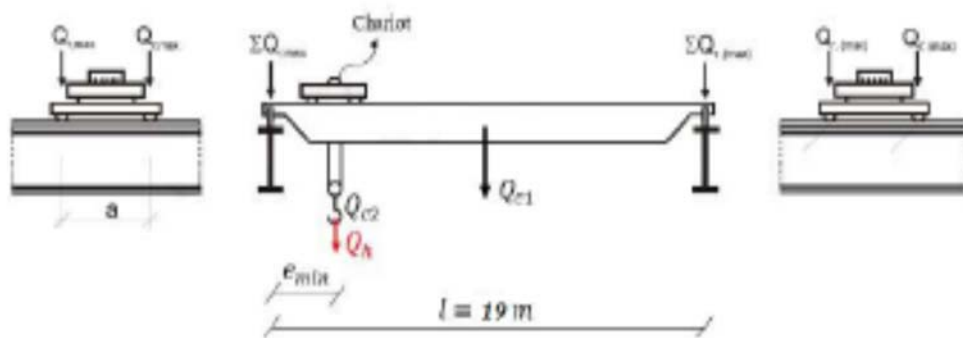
Position de l'appareil de levage en charge pour obtenir le chargement maximal de la poutre de roulement.
